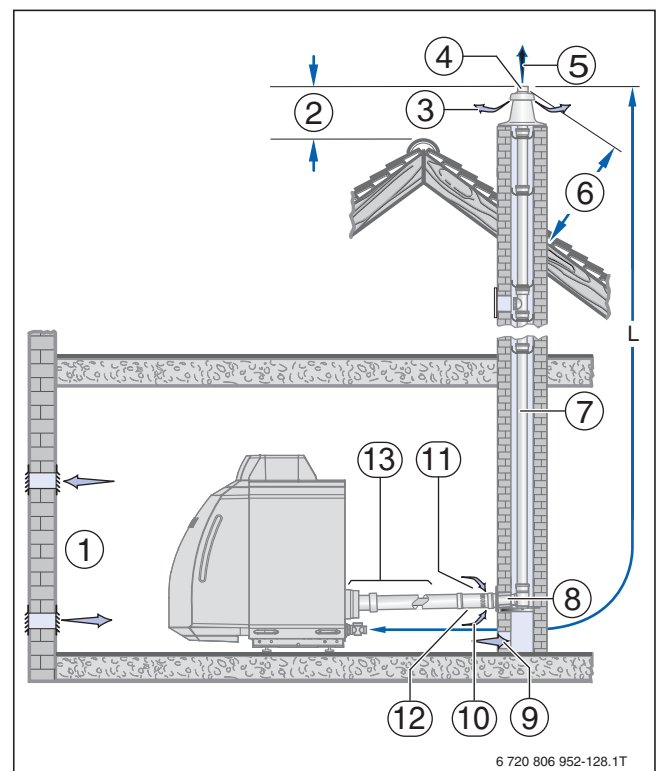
Montagevariante mit Bausatz GA-X in Verbindung mit Grundbausatz GA-K
